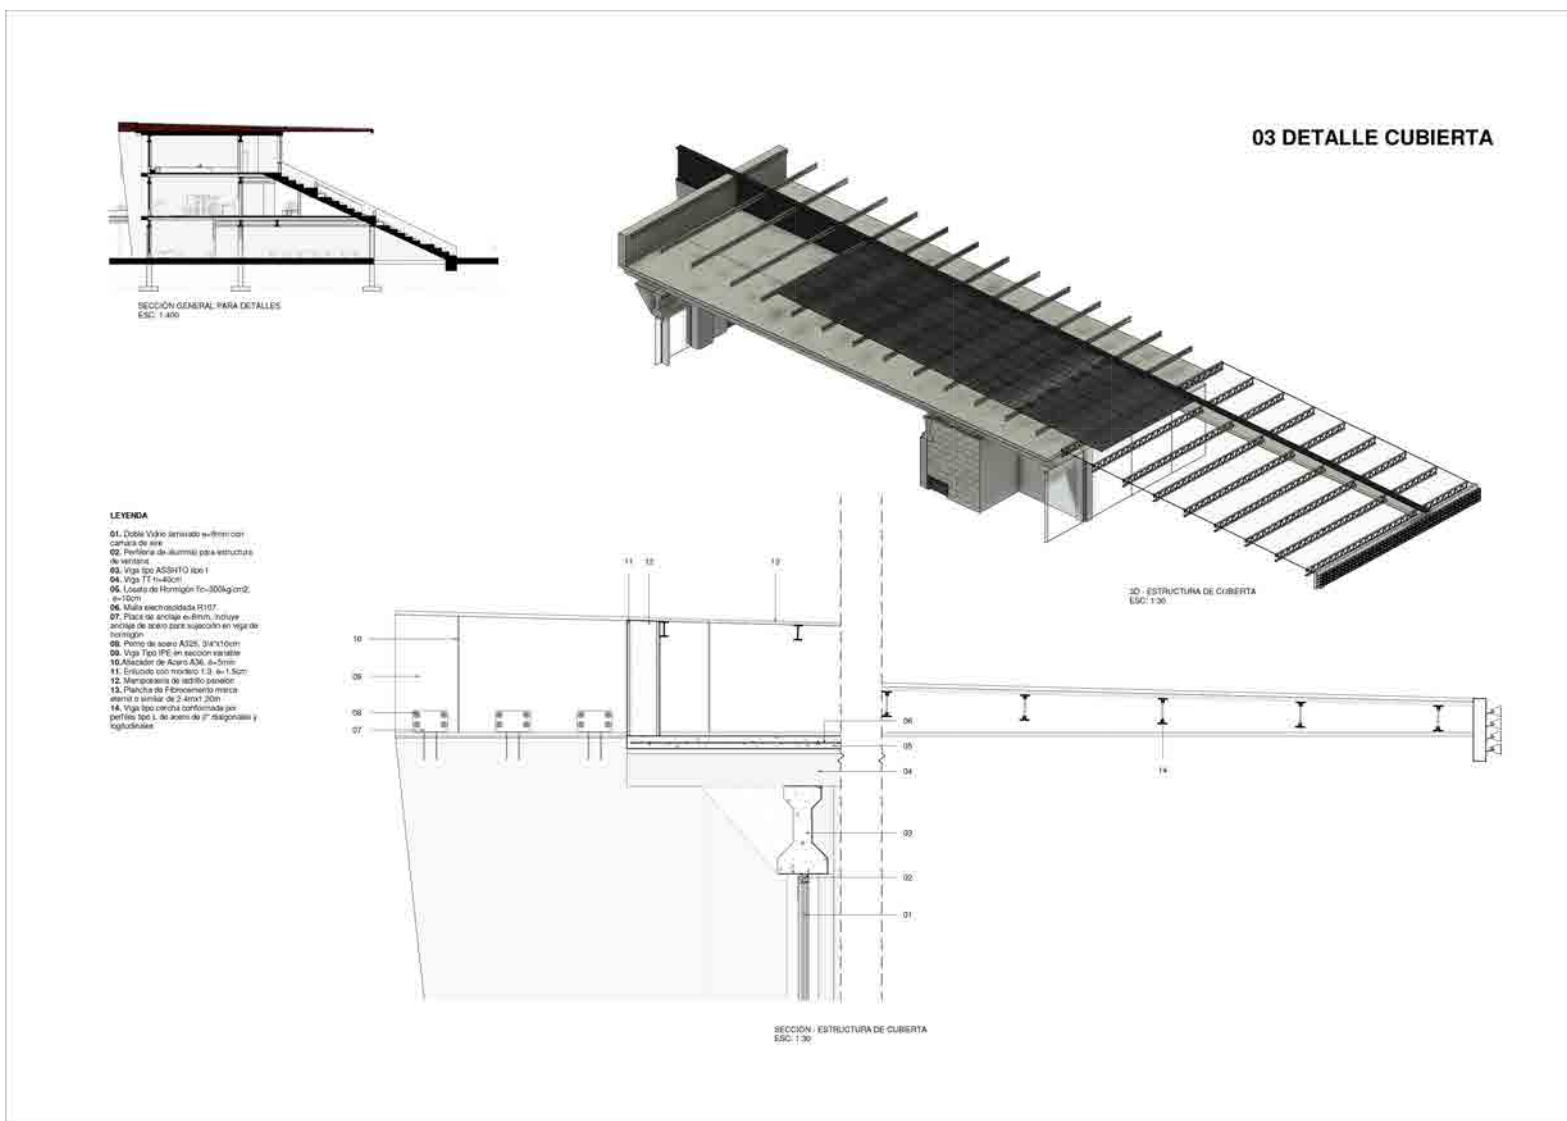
Detalle cubierta. Elaboración: Autores.
